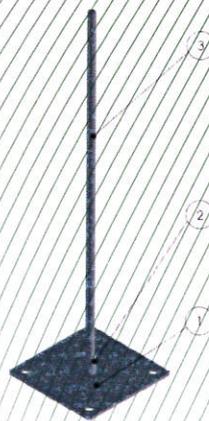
Anschlagereinrichtung, Typ: ZS 300-800 B / B-S / H / HD-SD / S / S-KP / B-KA
